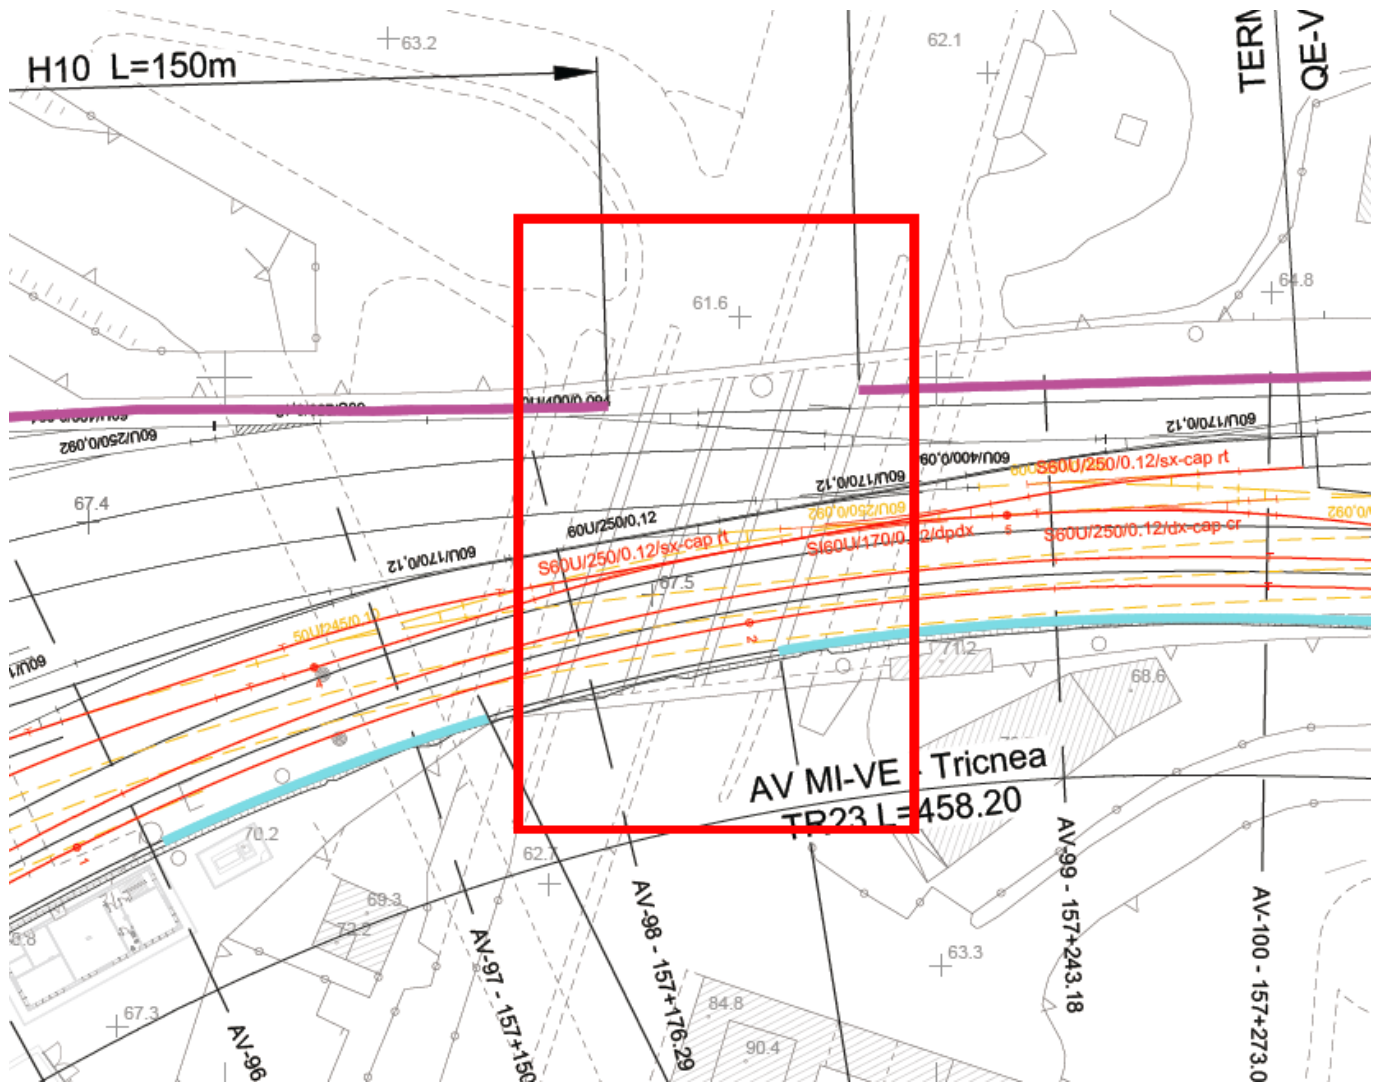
Planimetria dell'intervento del sottovia ferroviario, situato in corrispondenza del km 144+851
